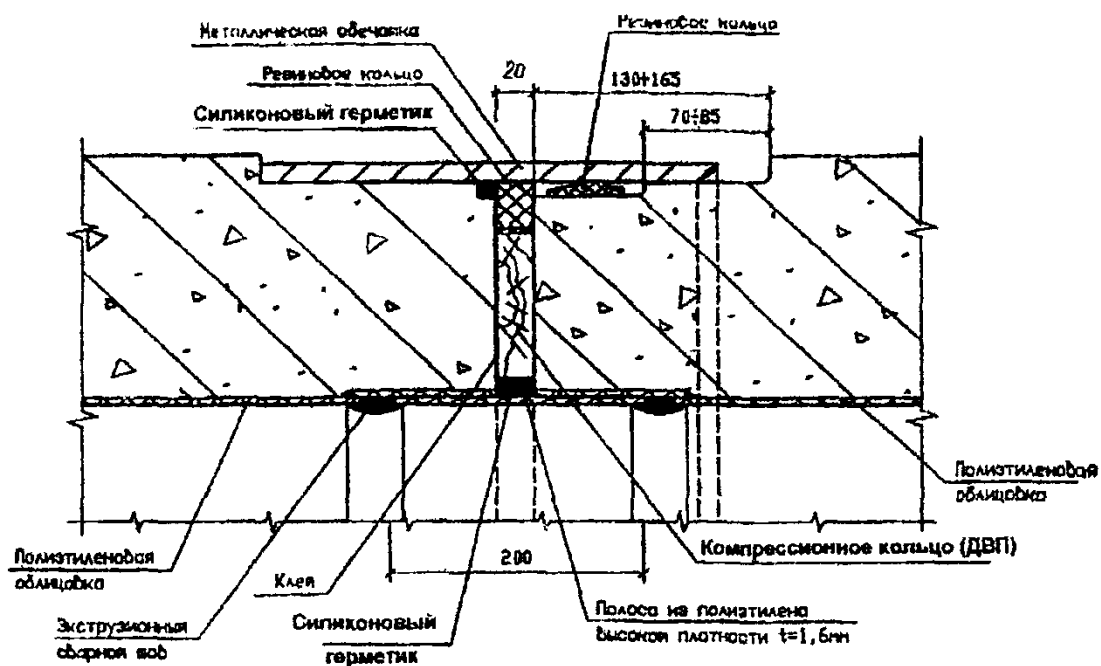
Схема стыкового соединения железобетонных труб ТСМО 100.300-1...ТСМО 200.300-3 с полиэтиленовой облицовкой
